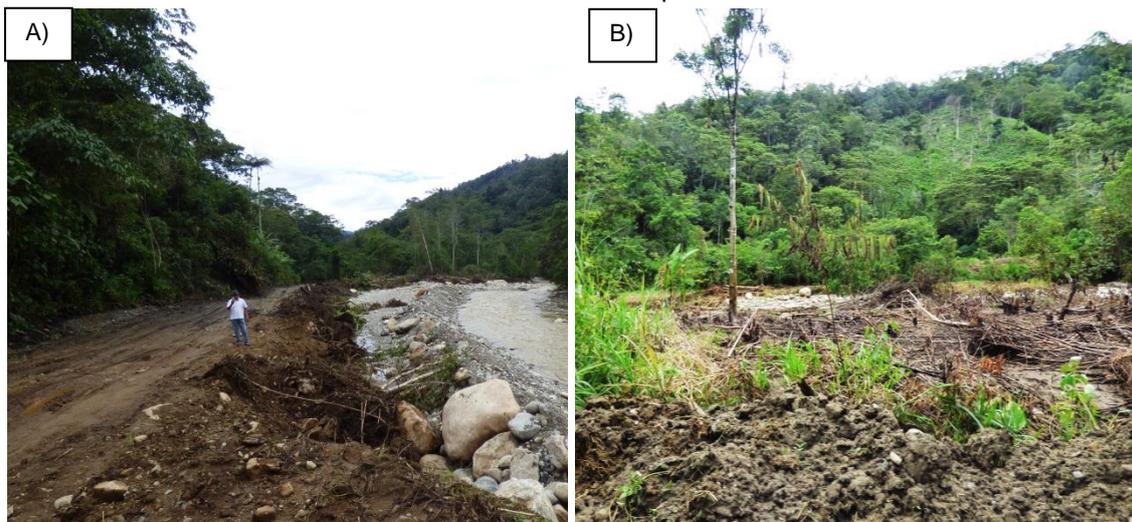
A) Vía Santa Rosa - La Florida inundada y restaurada, B) Cultivos dañados por la avenida del río.
